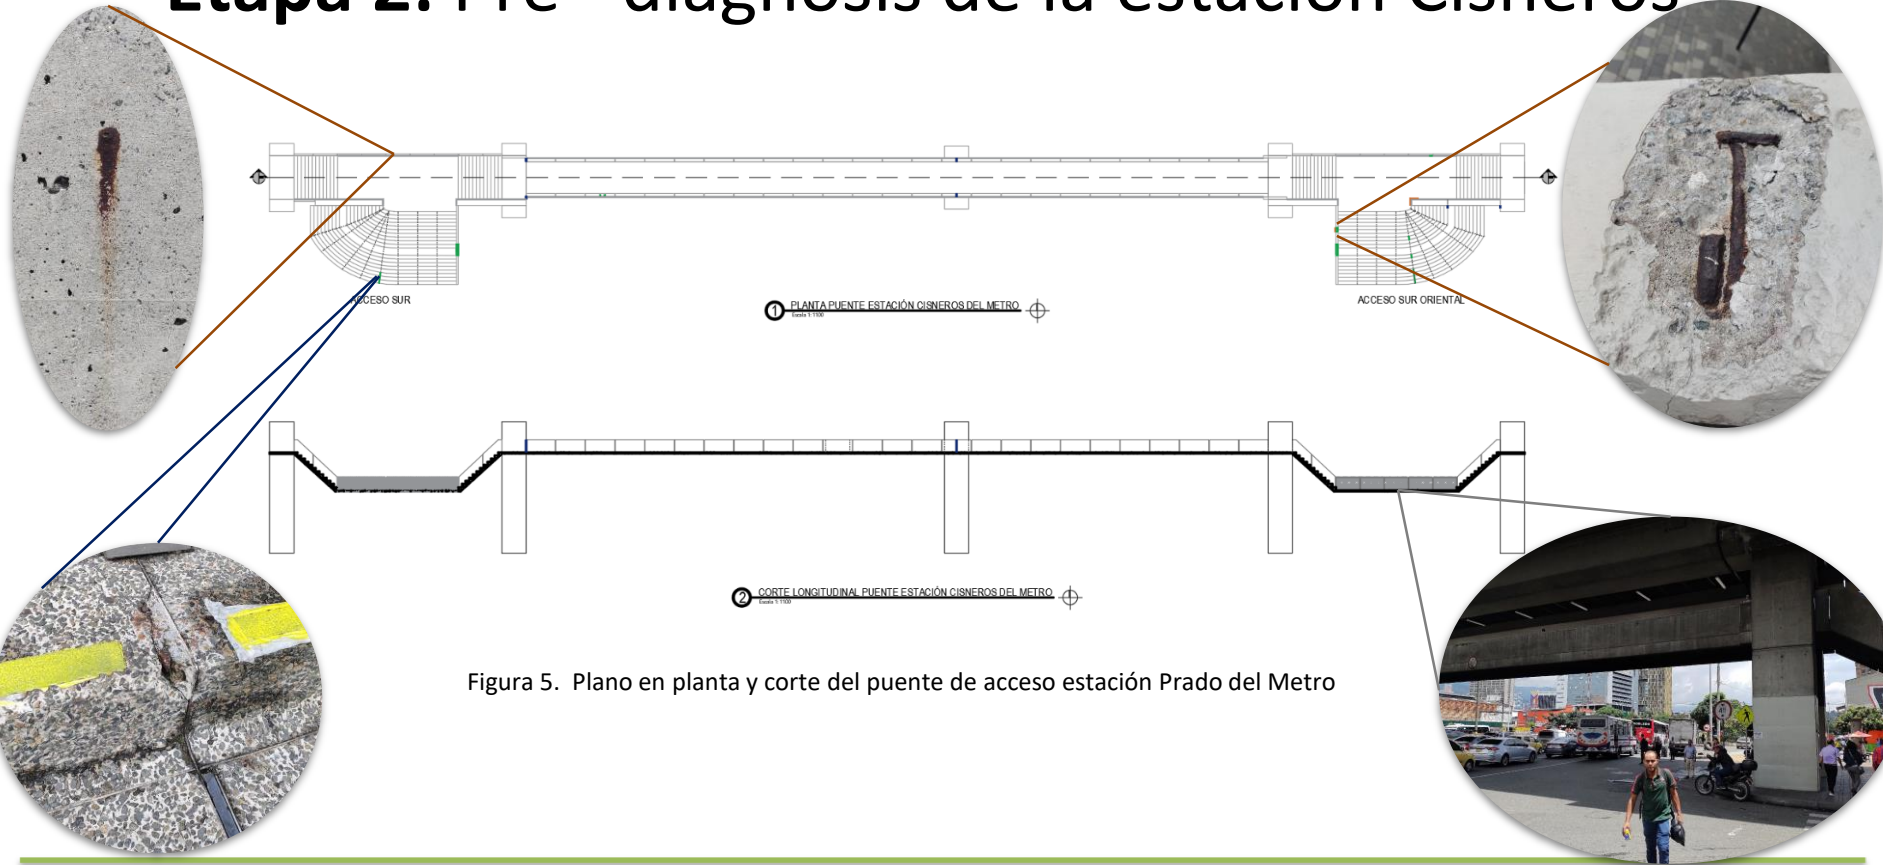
Plano en planta y corte del puente de acceso estación Prado del Metro
